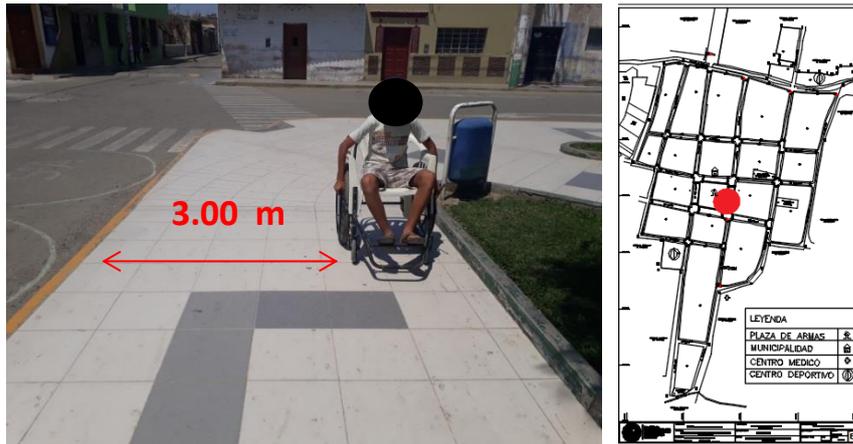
Veredas de la ciudad de Jequetepeque (perimetro de Plaza de Armas) con anchos de vereda de 3 m (Calle Guadalupe en la Plaza de Armas)
